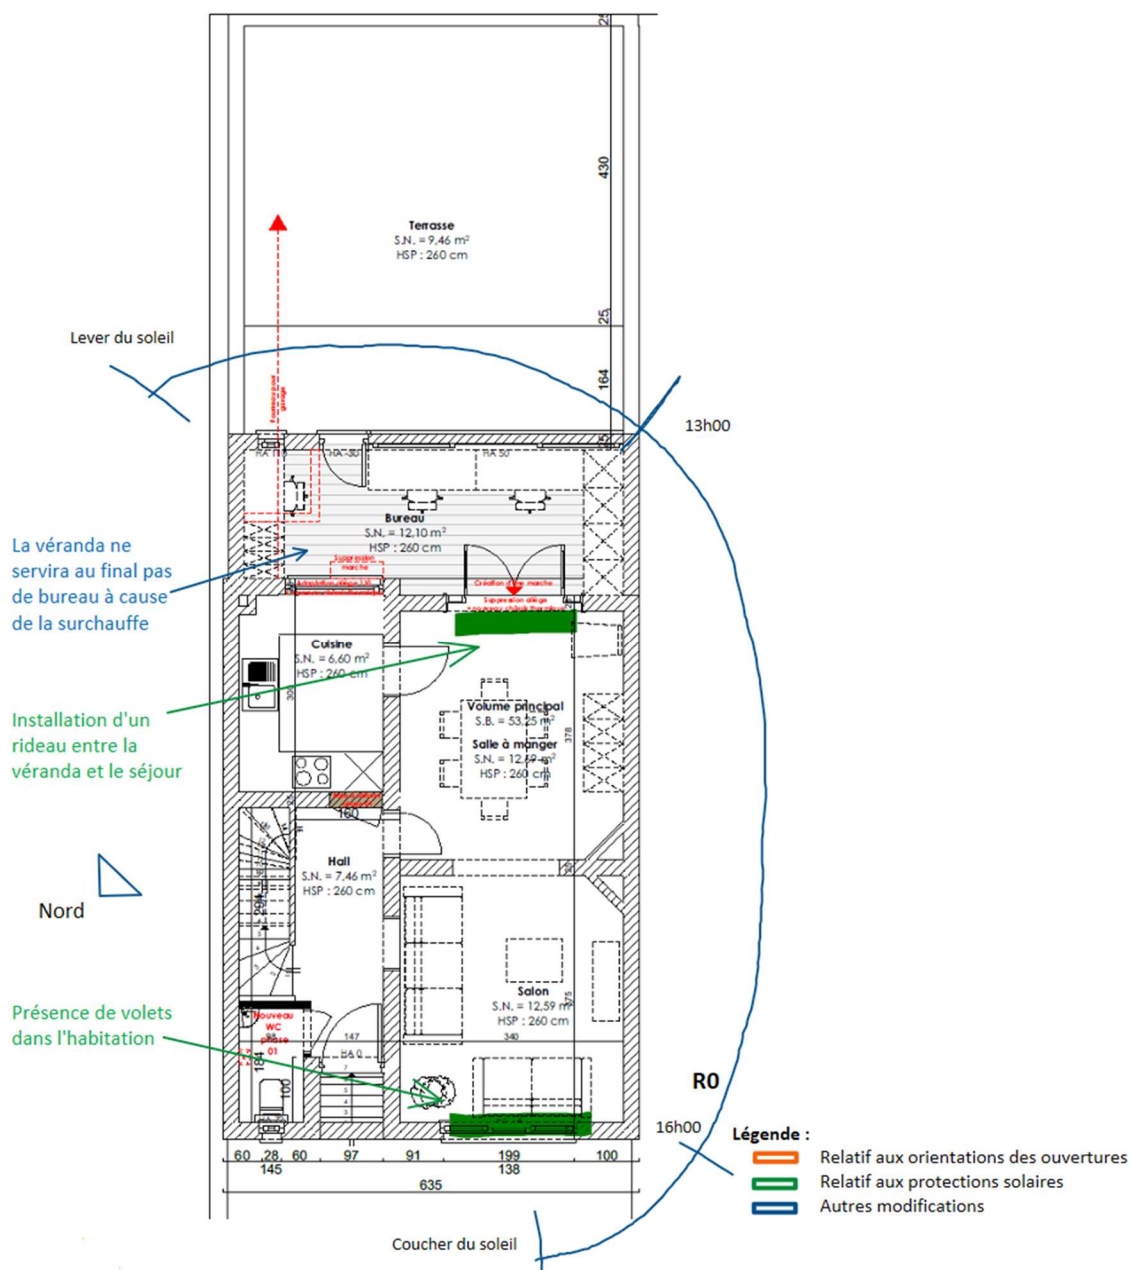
Architecte 1 : Logement 2 : R0 : Surchauffe
